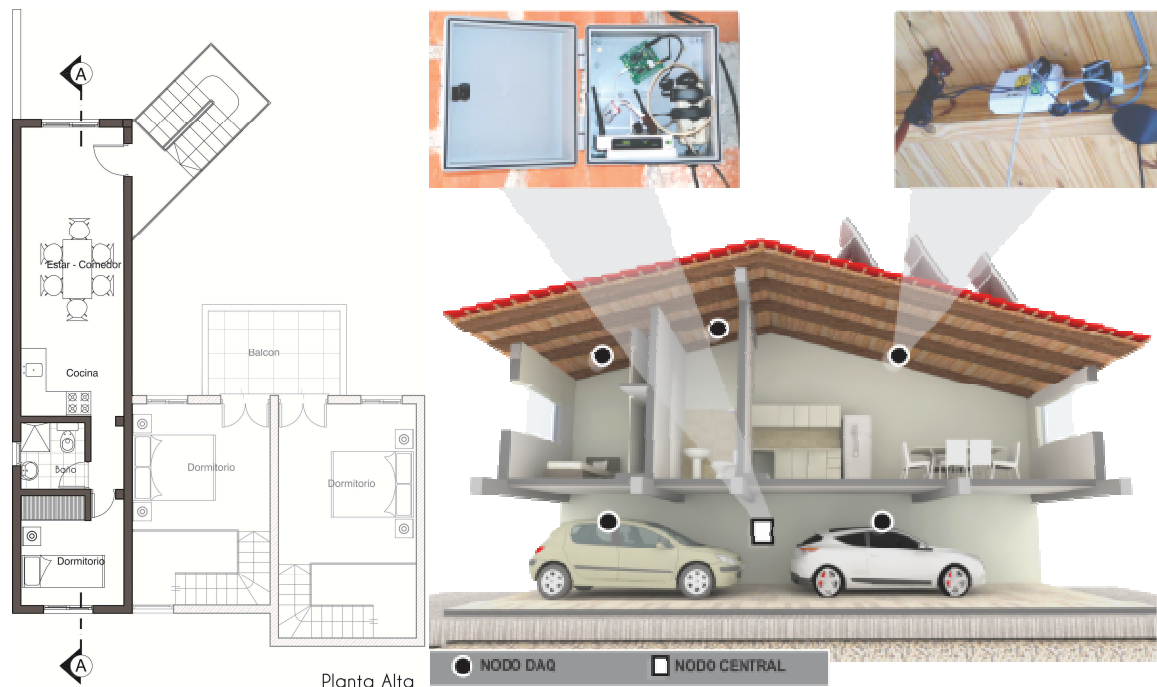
Esquema de planta y corte transversal de la vivienda instrumentada y los principales componentes del sistema de adquisición y control.
